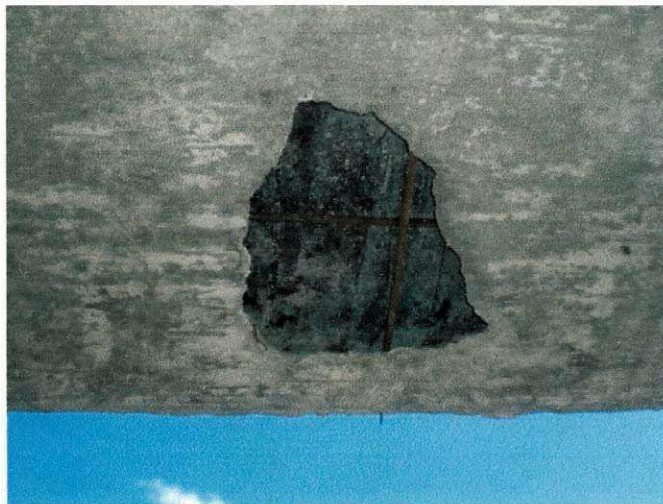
Problema estrutural em uma laje: armadura descoberta.
